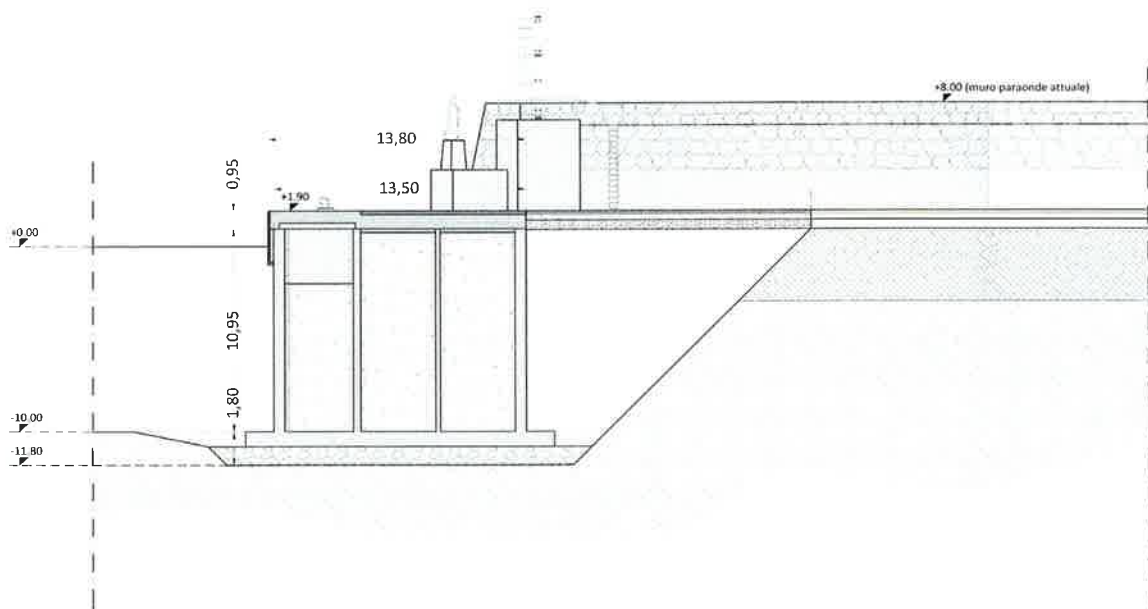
Sezione tipo cassoni della resecazione della Banchina Alti Fondali
